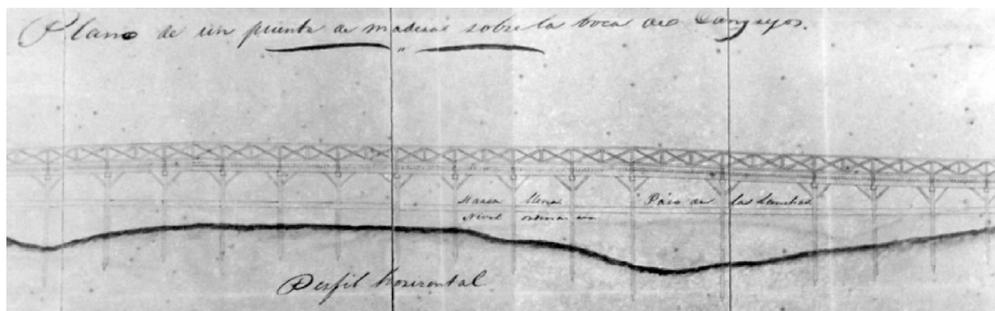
Plano de un puente de madera sobre la boca de [Río Cangrejos]. (Fuente: Archivo Genral de Puerto Rico, AGPR).
